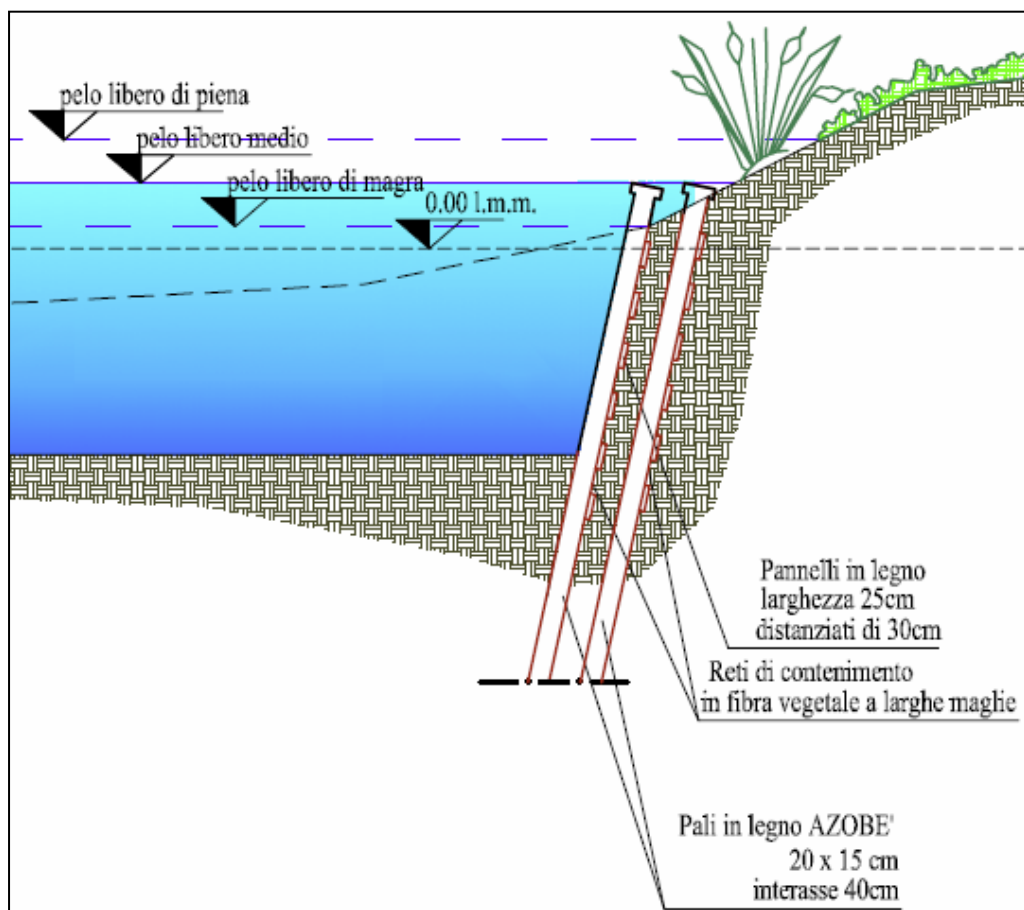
Sezione tipo della sistemazione spondale prevista nel Progetto Definitivo Generale
